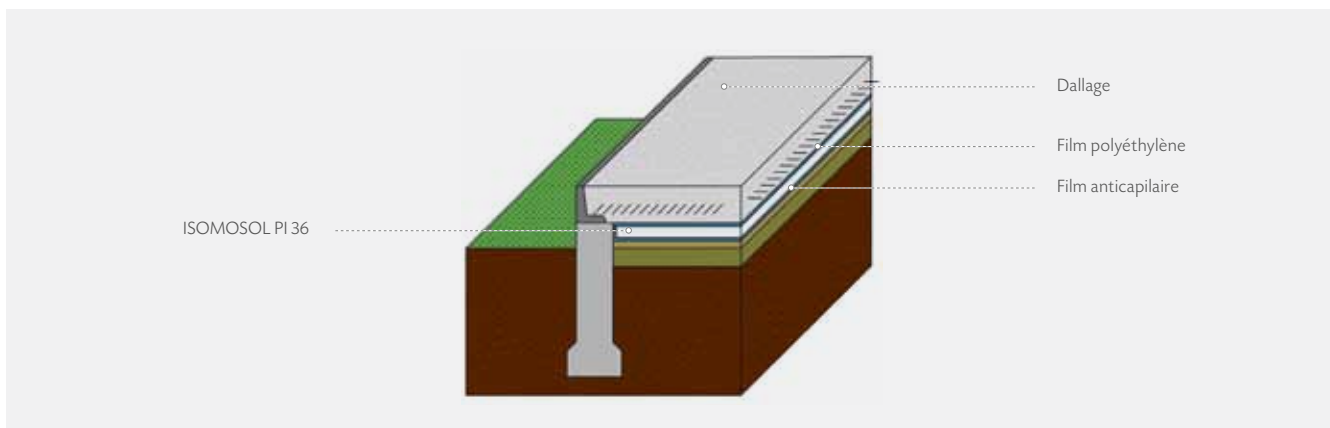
POSE SOUS DALLAGE - Dallage solidarisé
